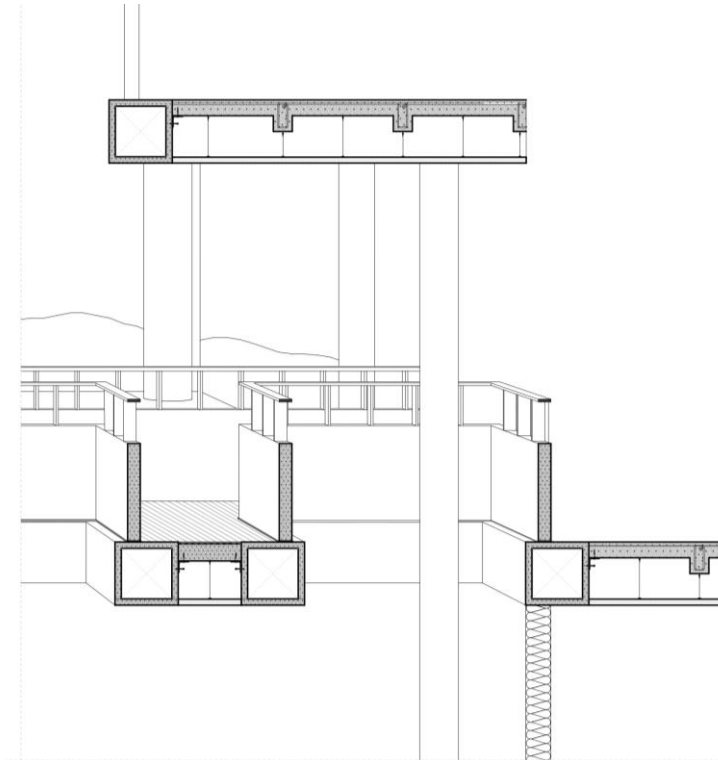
Detalle arquitectónico puentes. Elaboración propia
